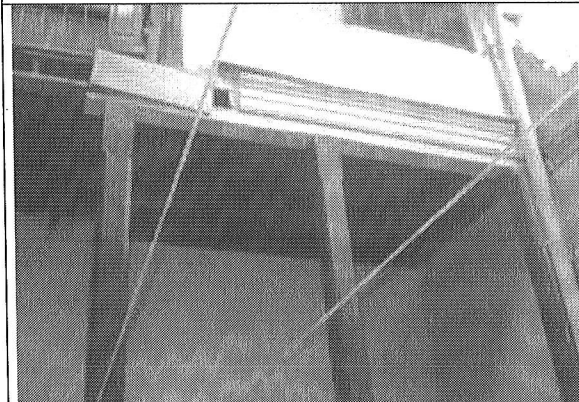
Estructura de madera de soporte del entrepiso en buen estado.
